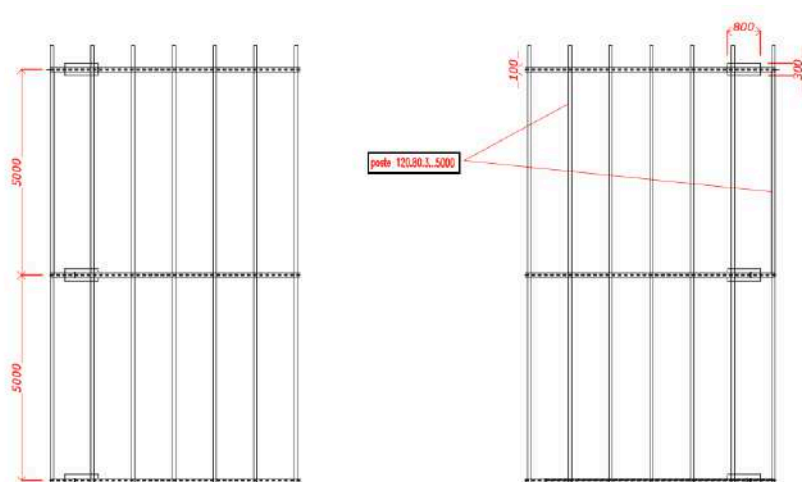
Detalle de las marquesinas desde la planta. Fuente: Galvexsa.SA
